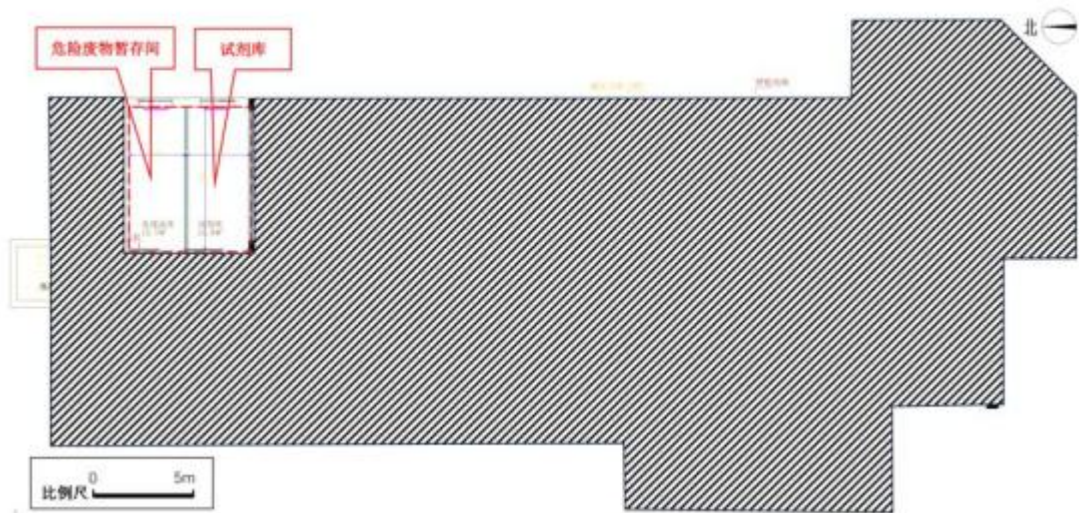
一层平面布置图（阴影部分为非本项目用房）
